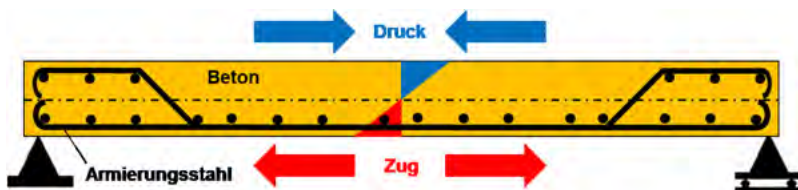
Querschnitt durch eine Stahlbetondecke (stark vereinfacht)
